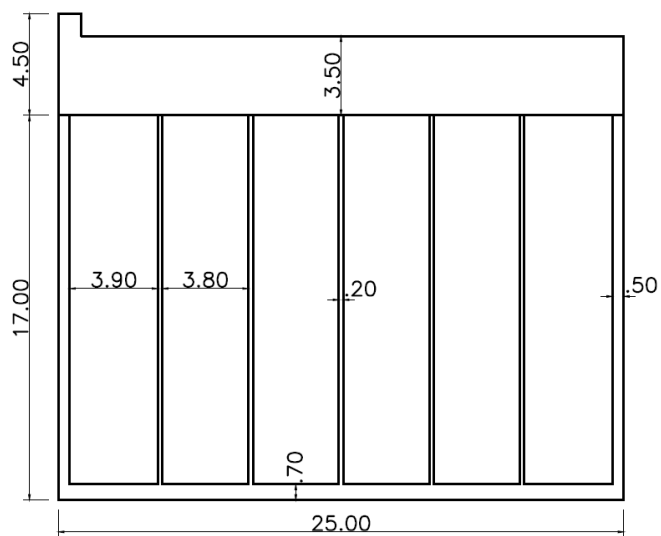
Caixão pré-dimensionado da seção 1. Dimensões em m.
